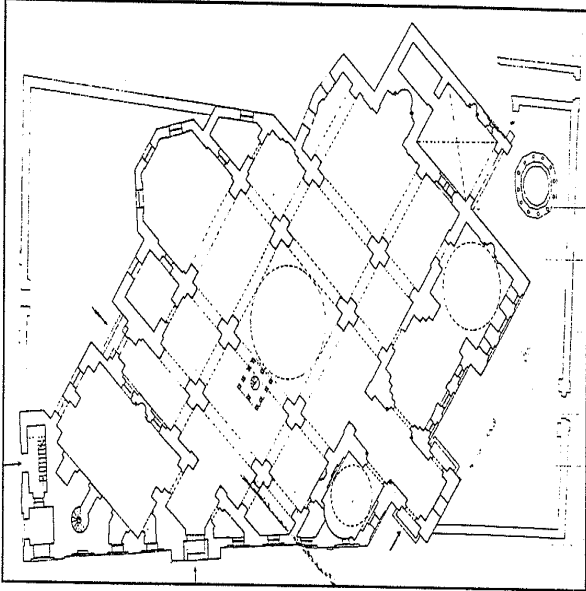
مسقط أفقي لمسجد كعب
